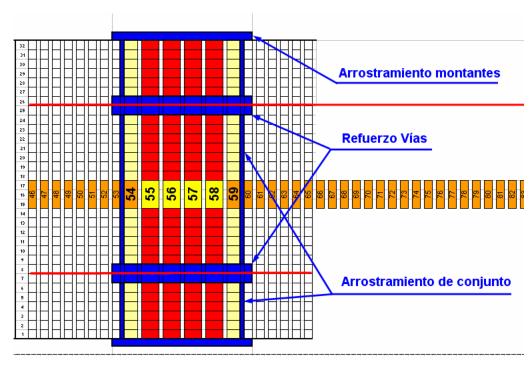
Refuerzo de la cubierta de hornos. Fuente Imasa.
